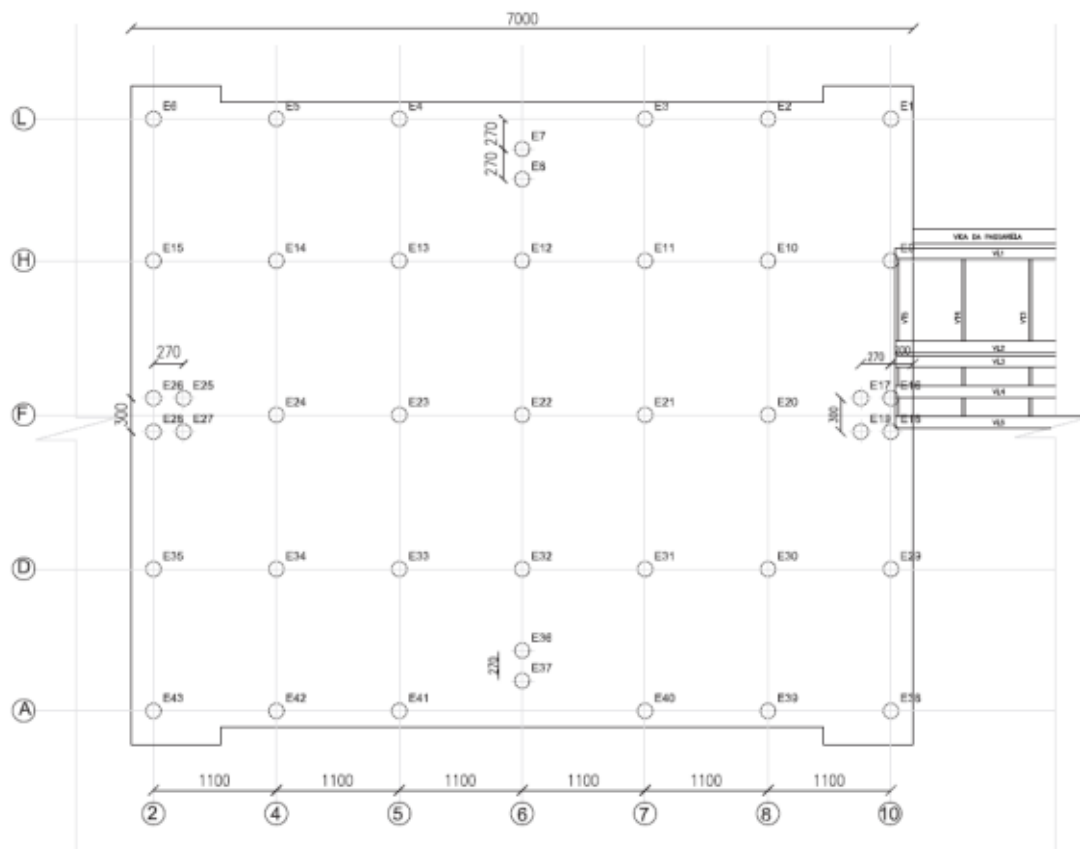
Planta Geral de Localização do Berço 106 e início da Ponte de Acesso
